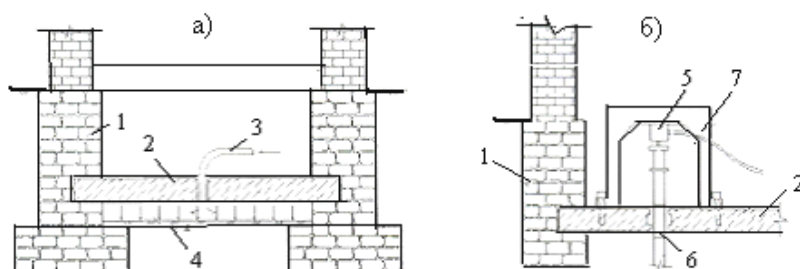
Увеличение опорной площади фундамента с помощью монолитной железобетонной плиты с опрессовкой грунта (а) или подведением многосекционных свай вдавливания (б)
